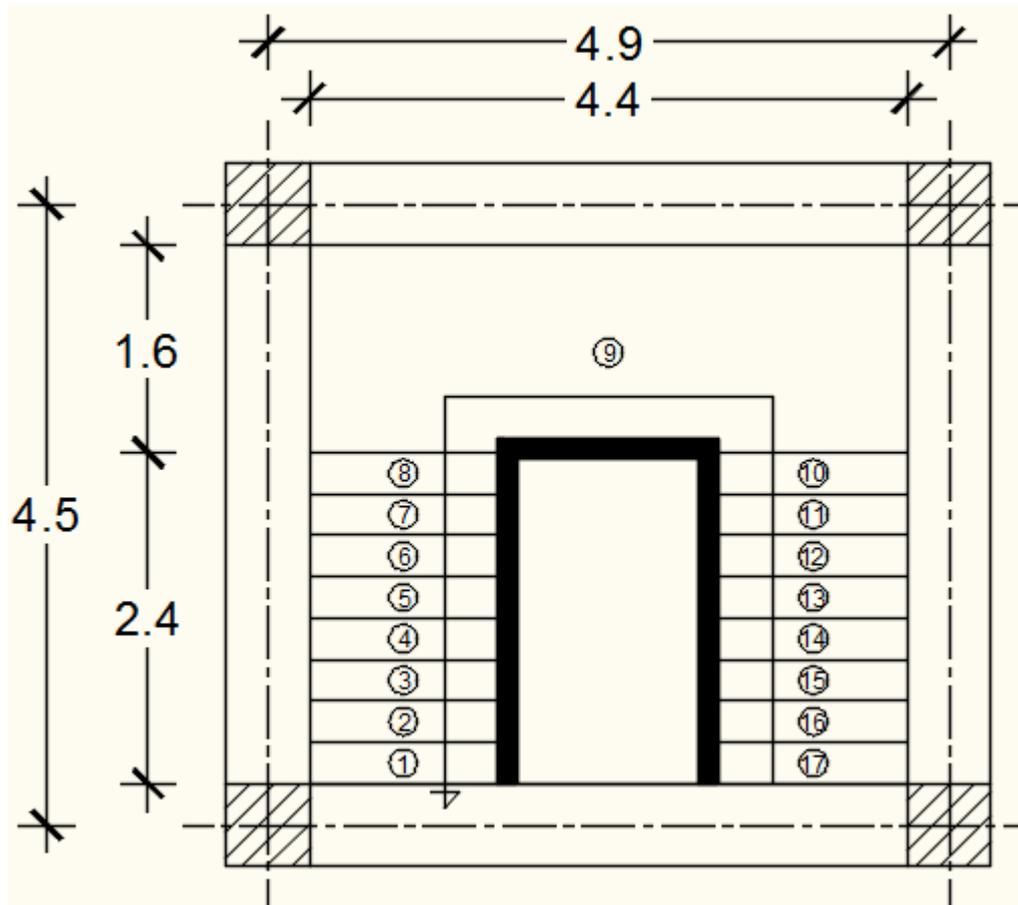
Vue en plan de la cage d'escalier type2.
